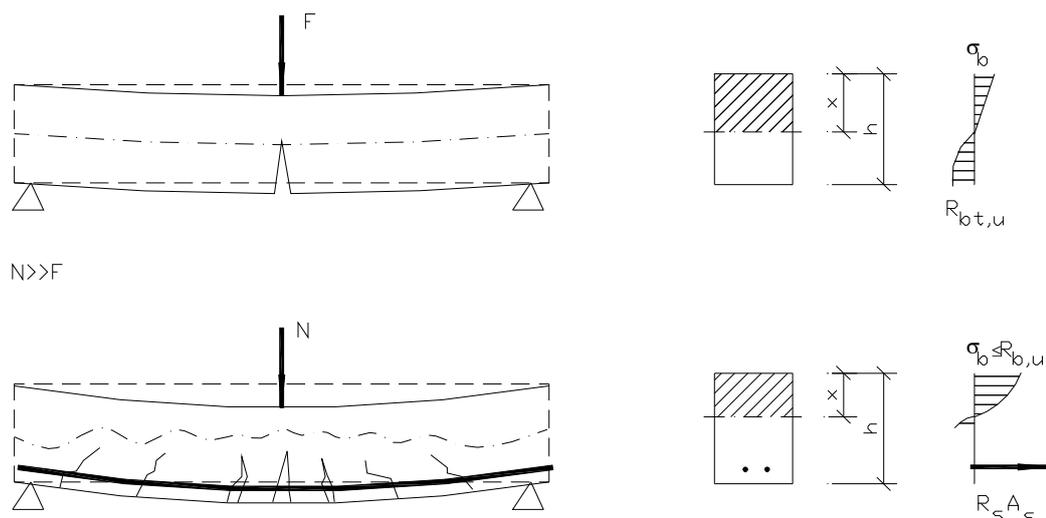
Сопоставление поведения под нагрузкой бетонной и железобетонной балок:
